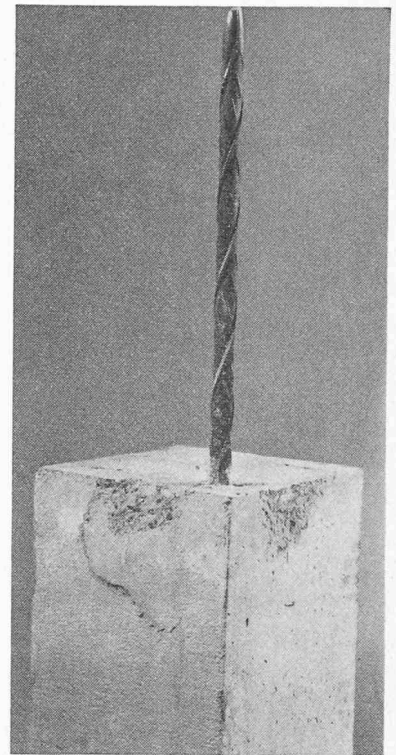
Ancrage d'angle ; rupture de la barre en dehors de la zone d'ancrage. Début de fissuration du béton : frettage serré obligatoire sur toute la zone d'ancrage.
